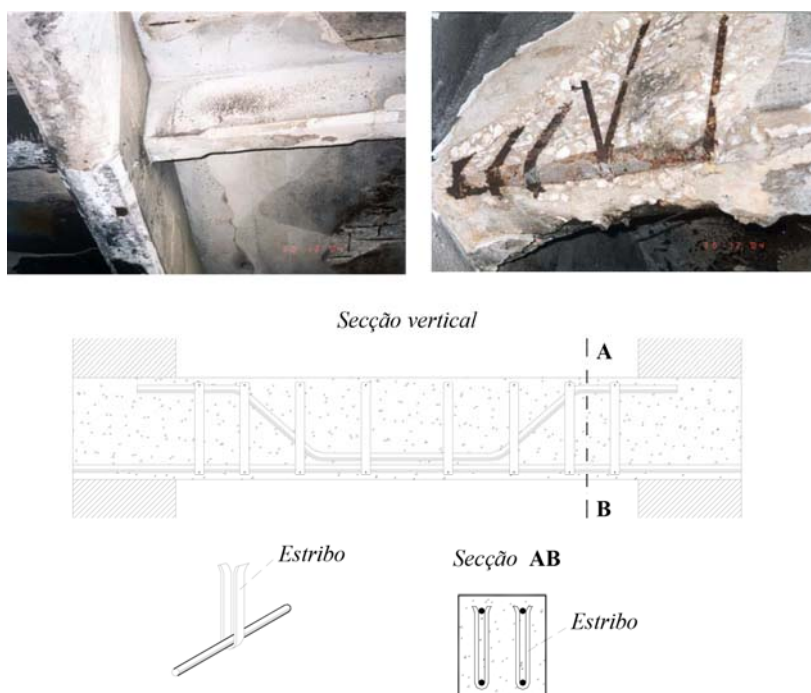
Sistema Hennebique – Pormenor estrutural e imagens de vigas aplicadas com o sistema Hennebique de um Armazém em Lisboa [4].
